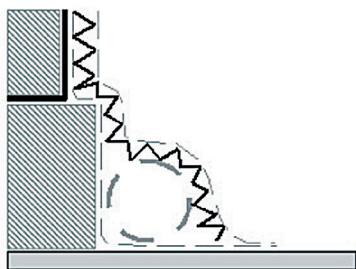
Установка дренажной трубы GeoDrain в основании фундамента
